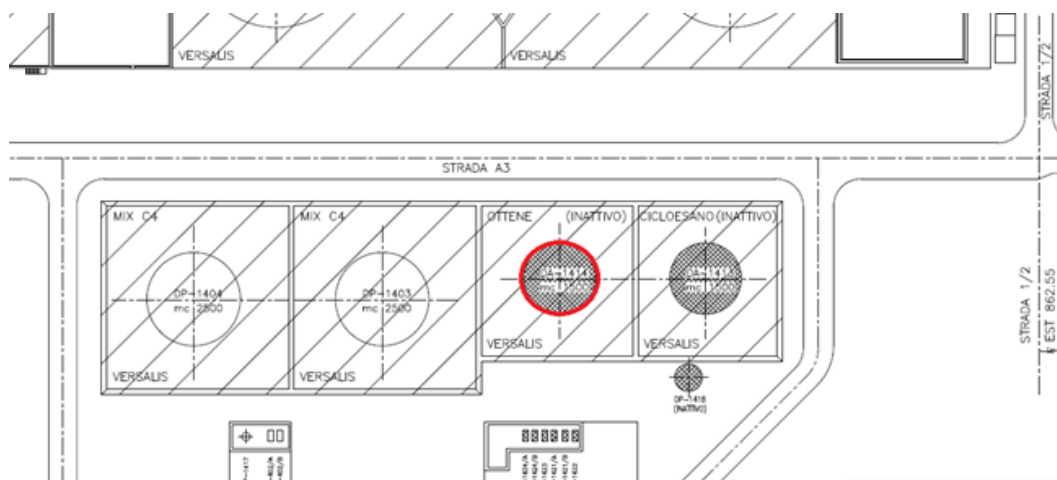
Stralcio planimetrico del serbatoio DA-1414 in area SG11
